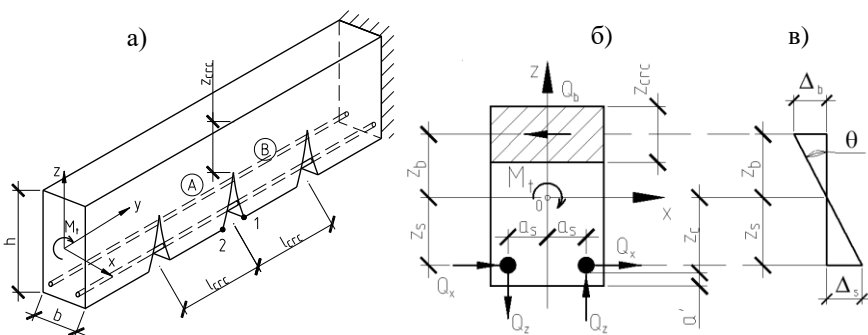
Схема железобетонного элемента с нормальными трещинами, подверженного кручению – а; схема усилий –б; схема поворота в сечении с трещиной – в
